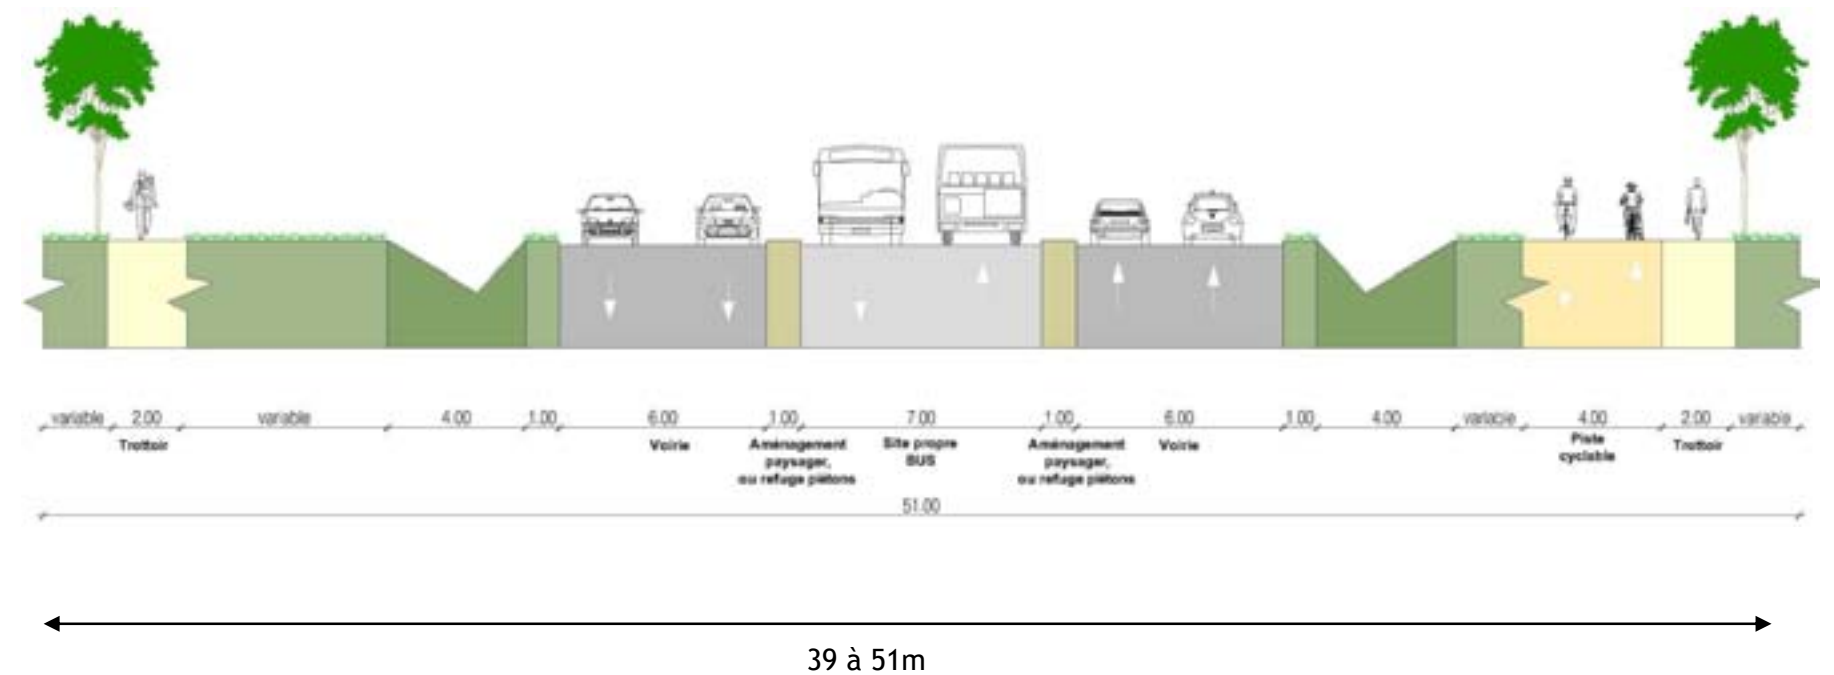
Profil en travers en section courante du secteur du Petit Ballainvilliers
